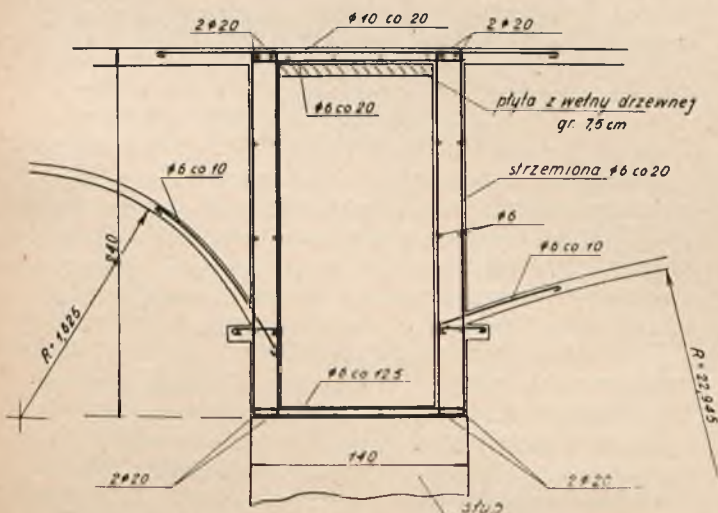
Plan konstrukcji żelbetowej ram, belek i płyt nad przebitymi otworami.
